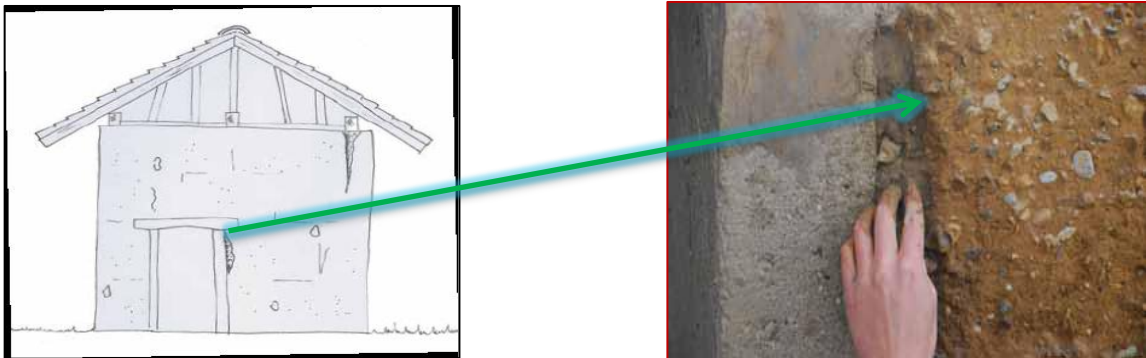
Exemple de rebouchage d'une mini-fissure comblée
